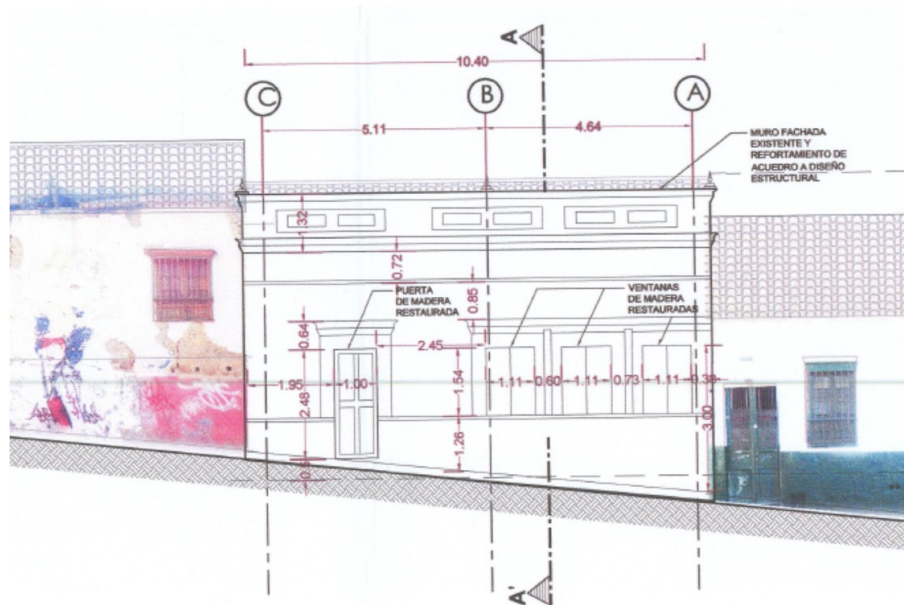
Recorte de la fachada propuesta en la planimetría aprobada mediante Resolución IDPC No 668 de 17 de octubre de 2017.
